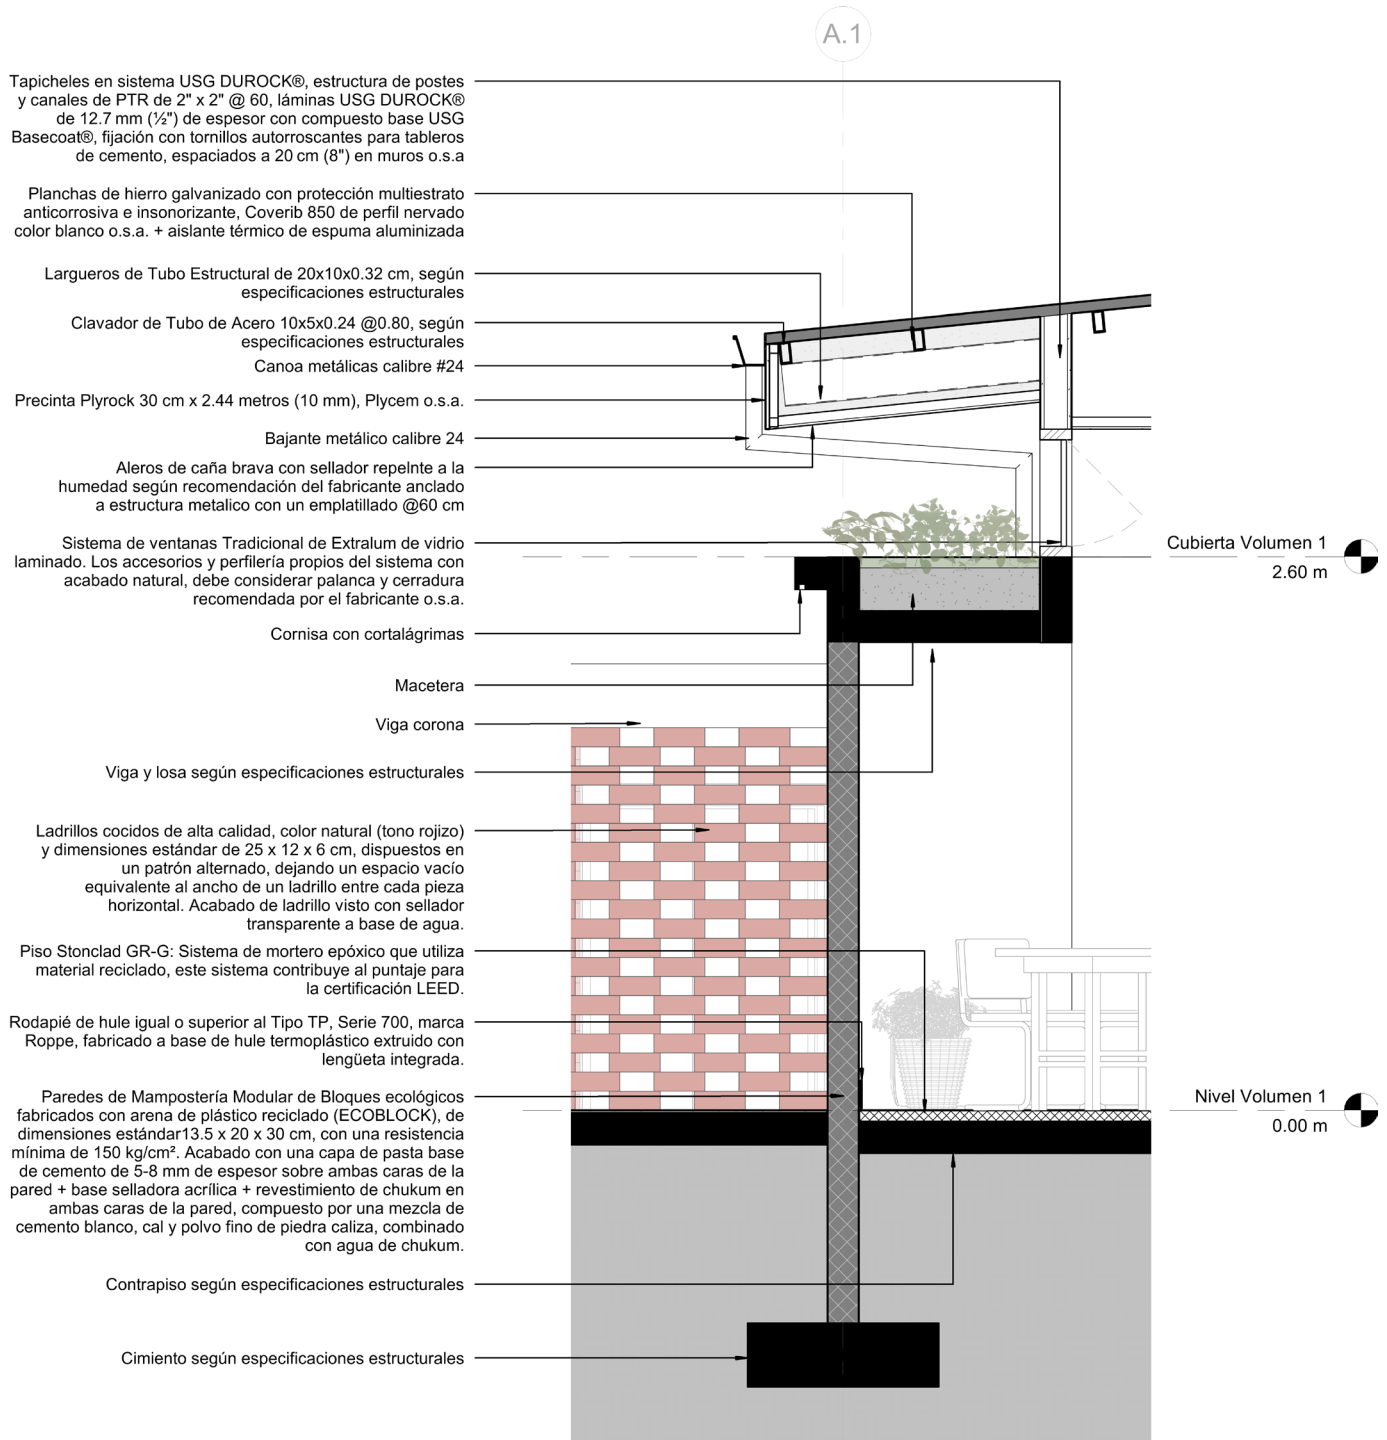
Detalle de Corte de Pared. Fuente: Elaboración propia
